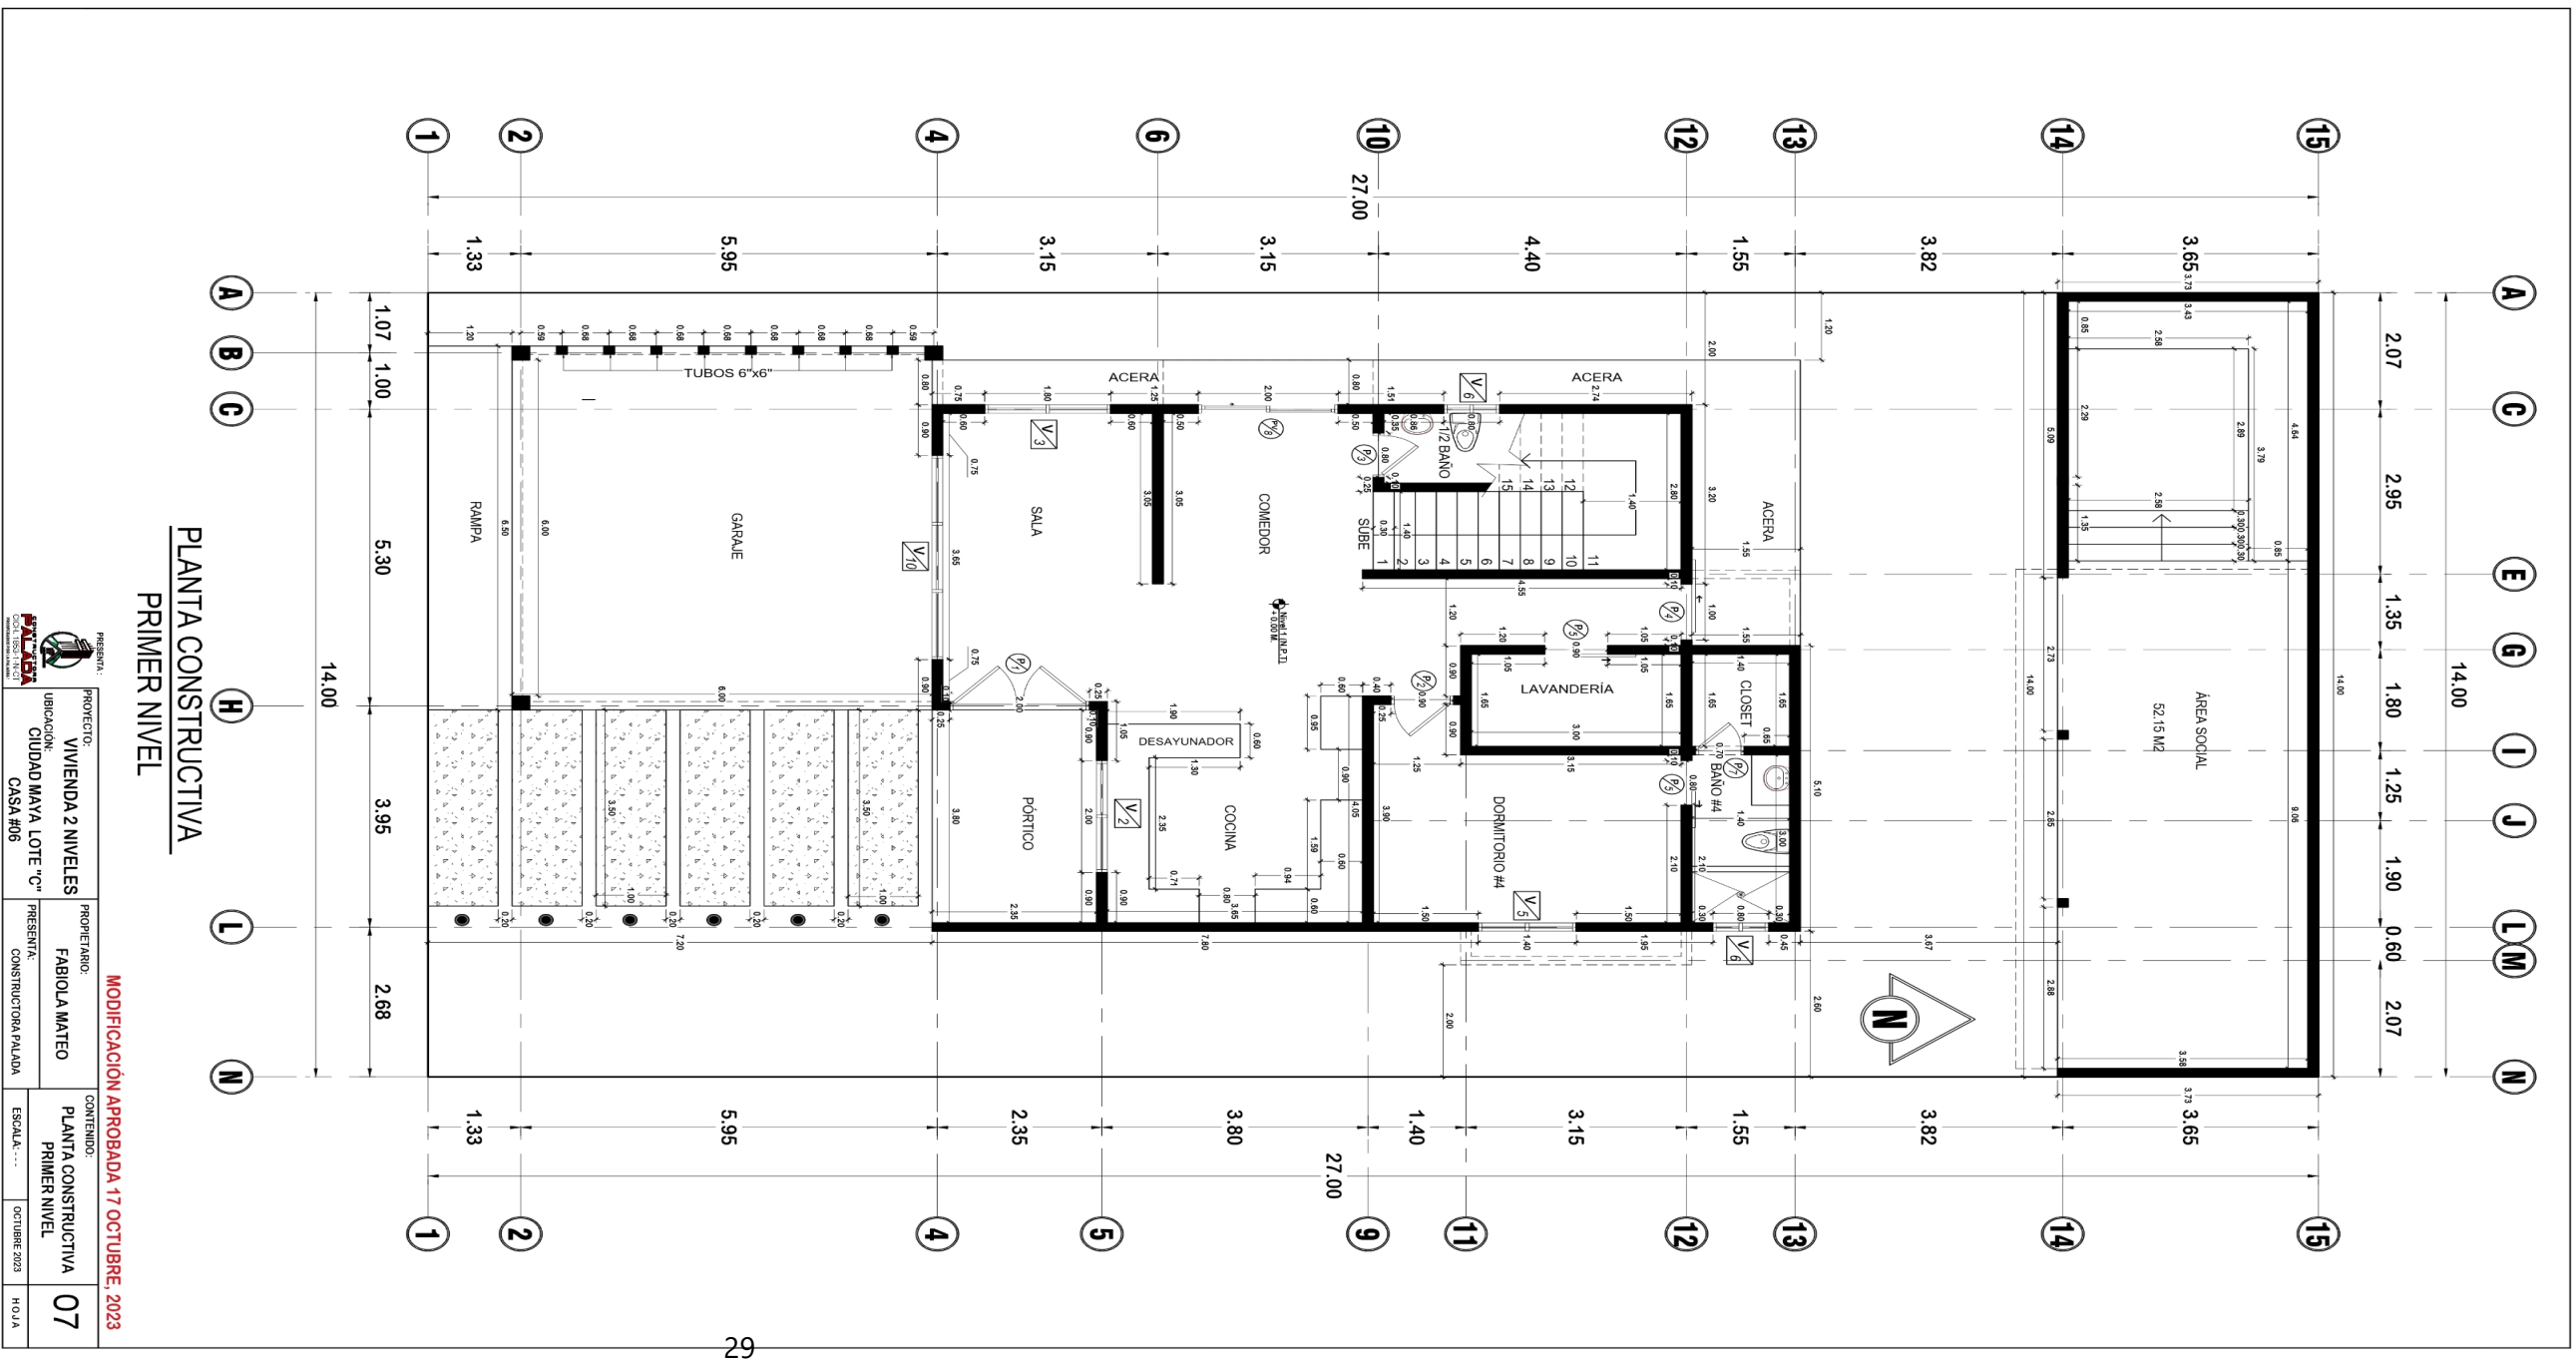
Plano de plantan constructiva primer nivel, casa de dos niveles
